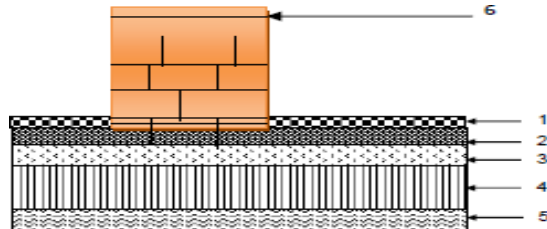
Coupe verticale d'un plancher étage courant à corps creux.
